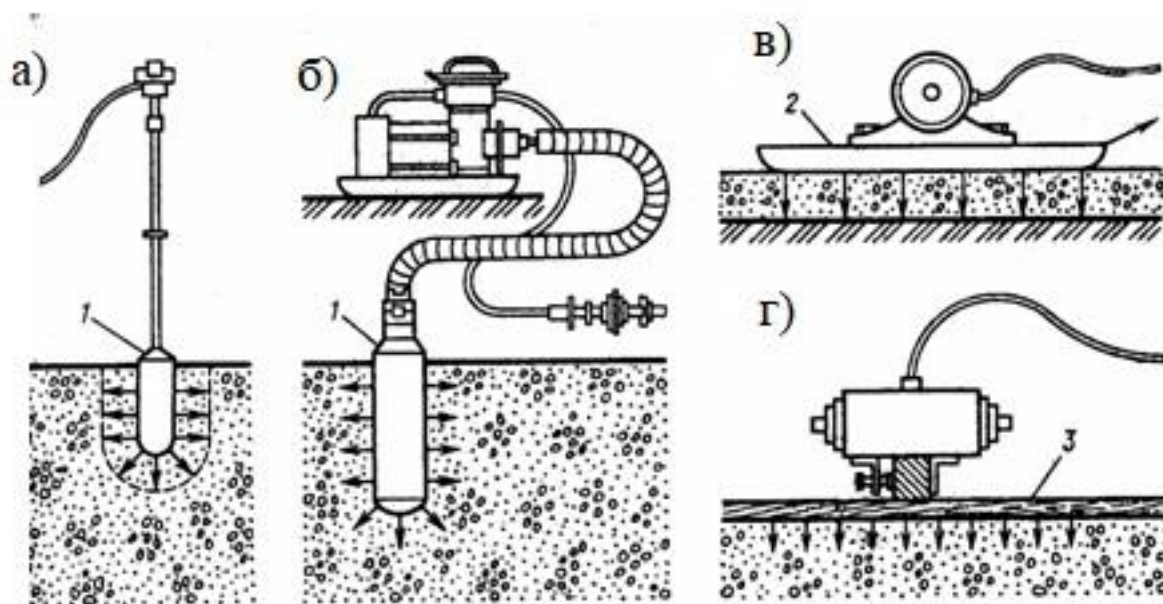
Вибраторы (1 – корпус, 2 – площадка, 3 – опалубка)
